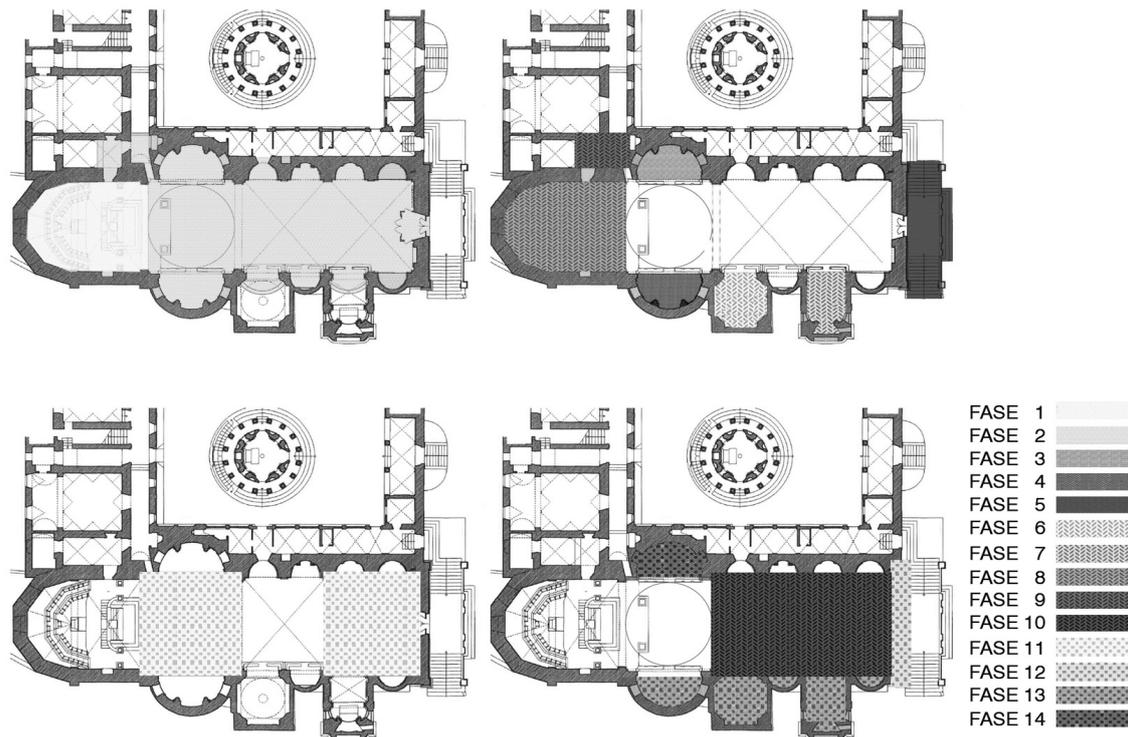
Fases constructivas Chiesa de San Pietro in Montorio
